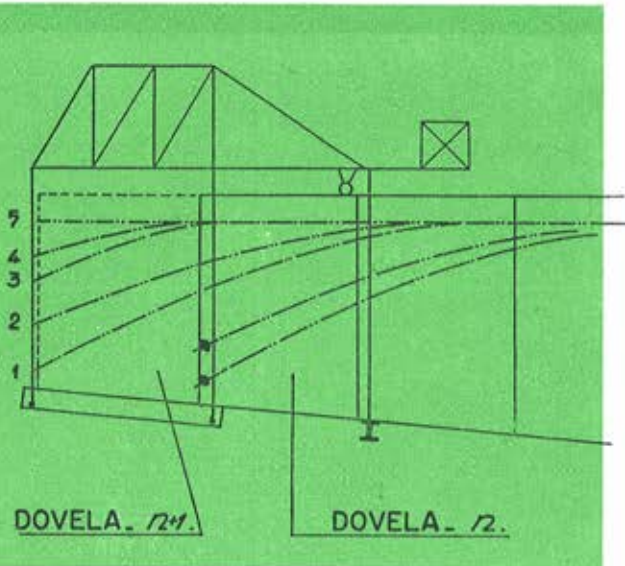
Esquema del proceso de ejecución de una dovela. Endurecido el hormigón de la dovela n se tesan los cables que en ella se anclan. Se traslada el entramado móvil, se ajusta el encofrado, se enhebran los cables 1 y 2, se colocan las vainas para los demás cables, se hormigona la dovela $n + 1$ y, una vez endurecido el hormigón, se tesan los cables 1 y 2.
